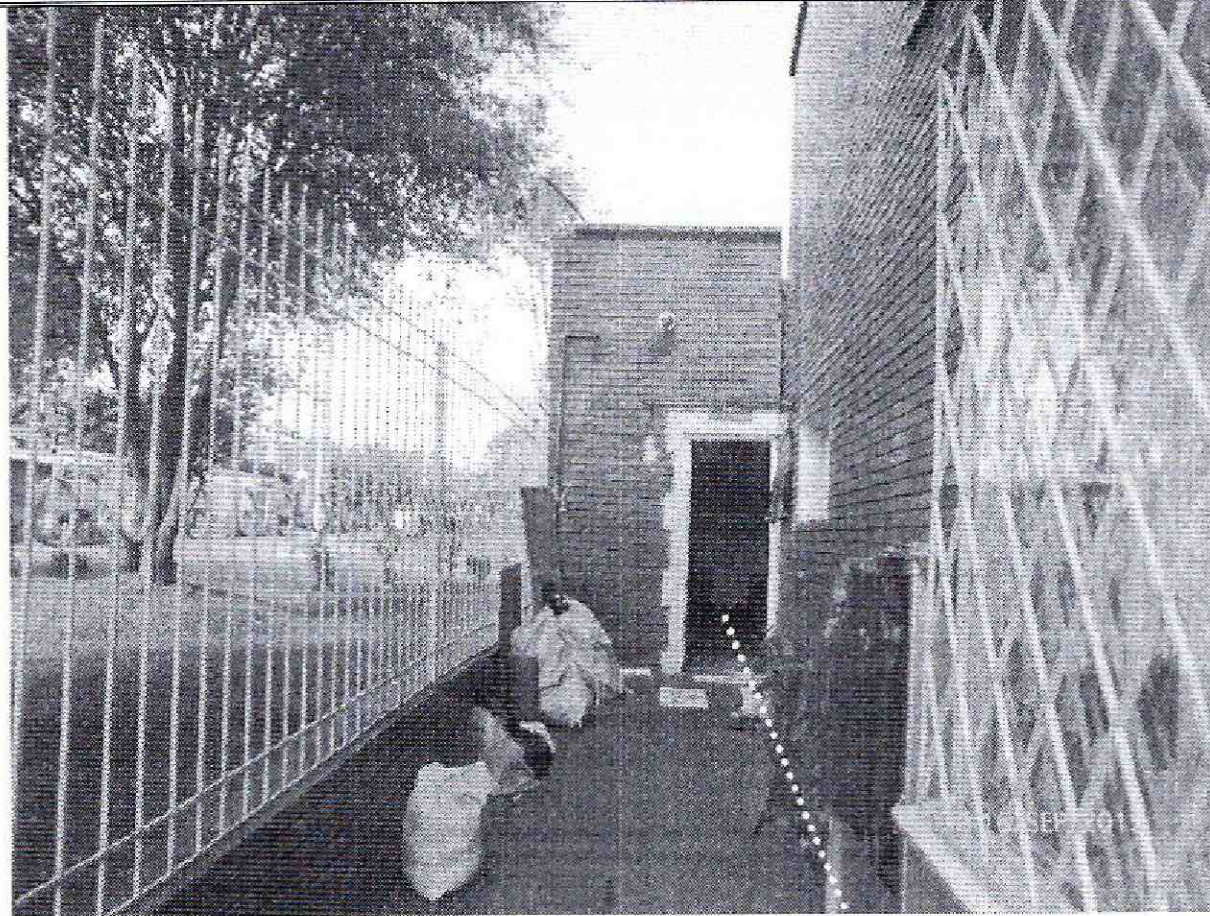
Vista frontal del predio de la Calle 95 No. 68 C – 38.
